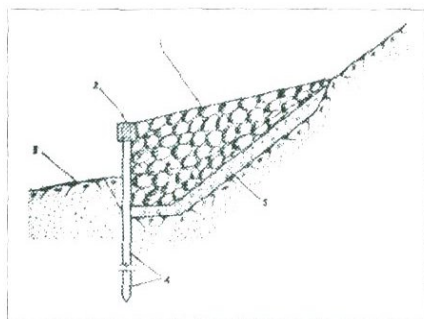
Конструкция берегоукрепительных стен из БМ-200 и фиксаторов с каменной наброской
